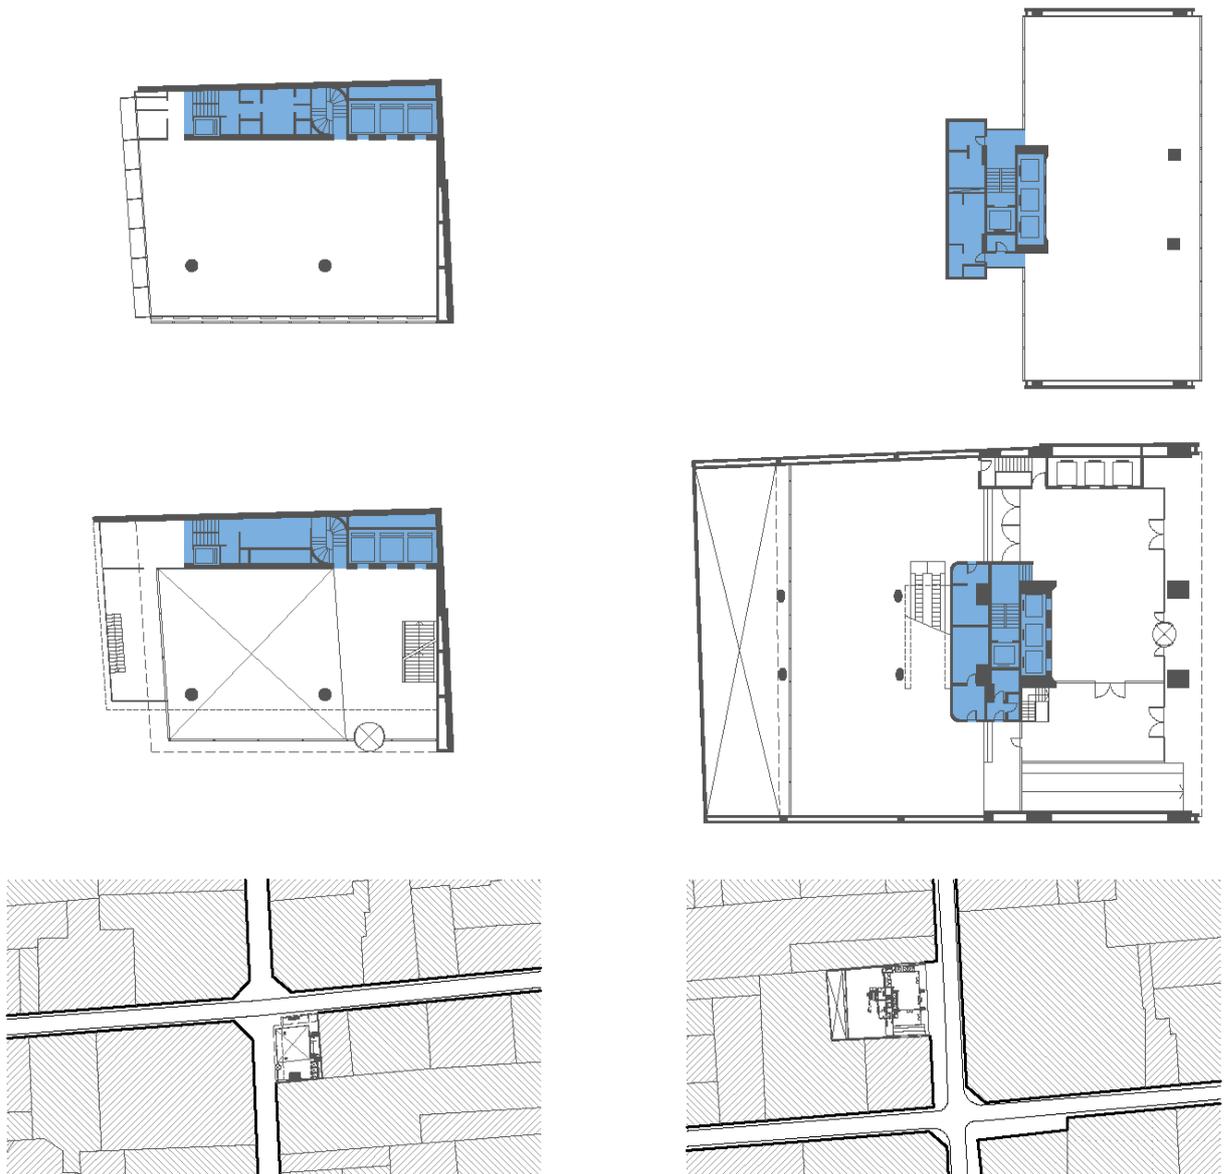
Planta Tipo, Edifício Panedille, 1964-1969.
